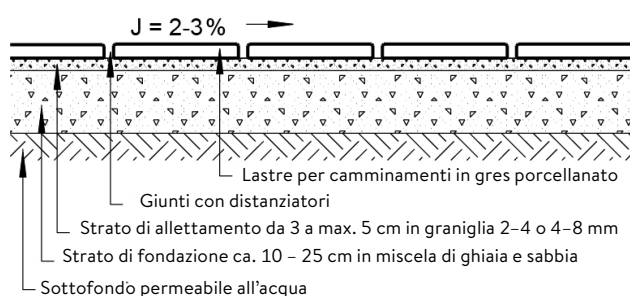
Struttura del rivestimento in lastre sopra uno strato di fondazione
